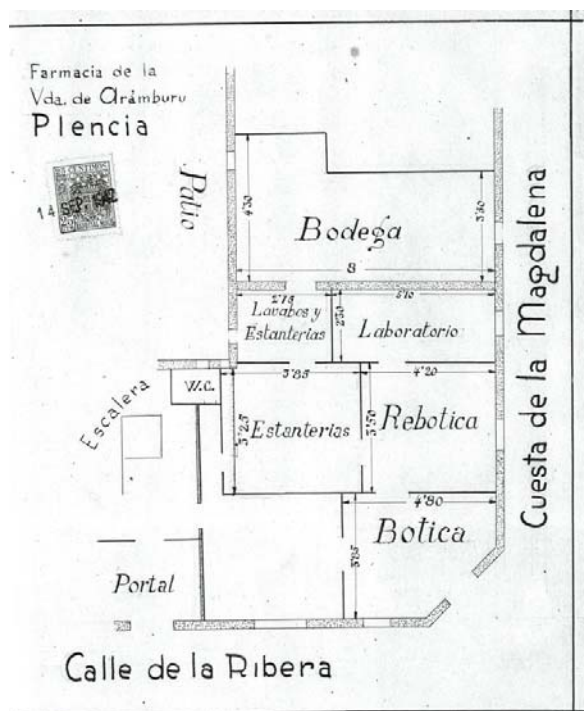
Plano adjuntado a la solicitud de apertura de María Gardoqui (Septiembre de 1942)
